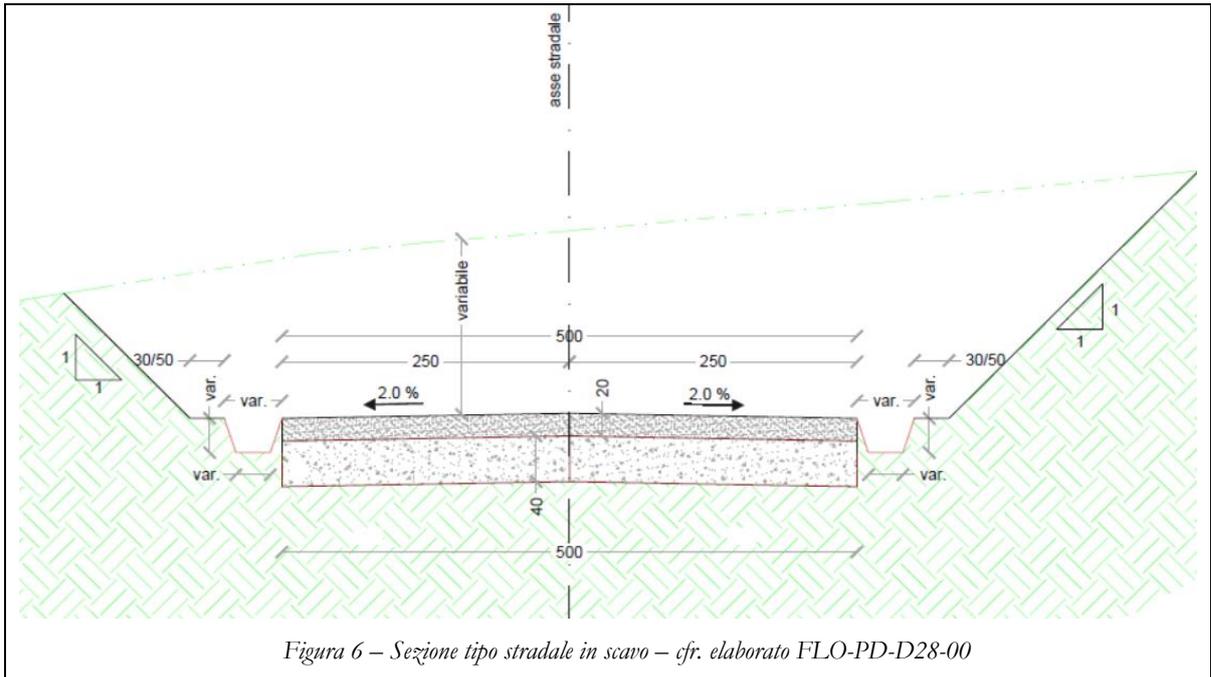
Sezione tipo stradale in scavo – cfr. elaborato FLO-PD-D28-00
